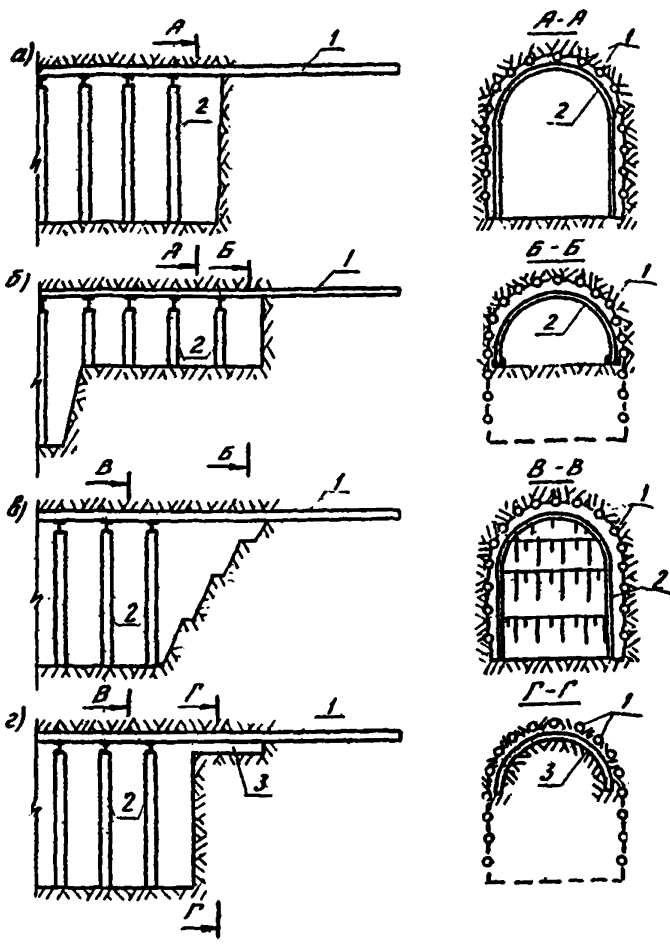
Схемы разработки грунта под защитой экрана из труб:
